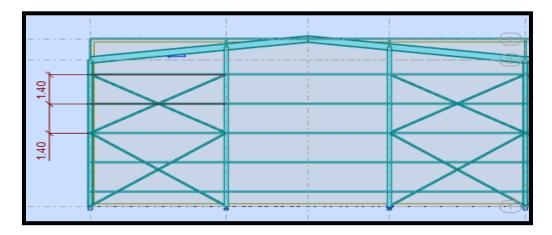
Coupe longitudinal sur les lisses de bardage.
